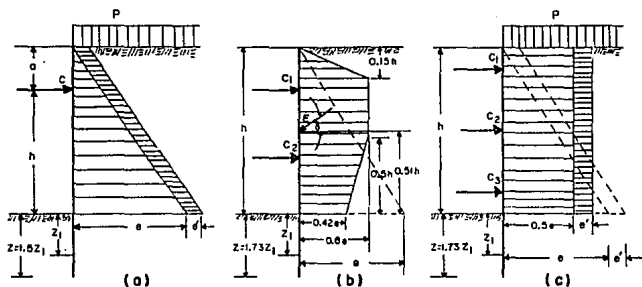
Redistribución de empujes en un ademe horizontal entre perfiles hincados
